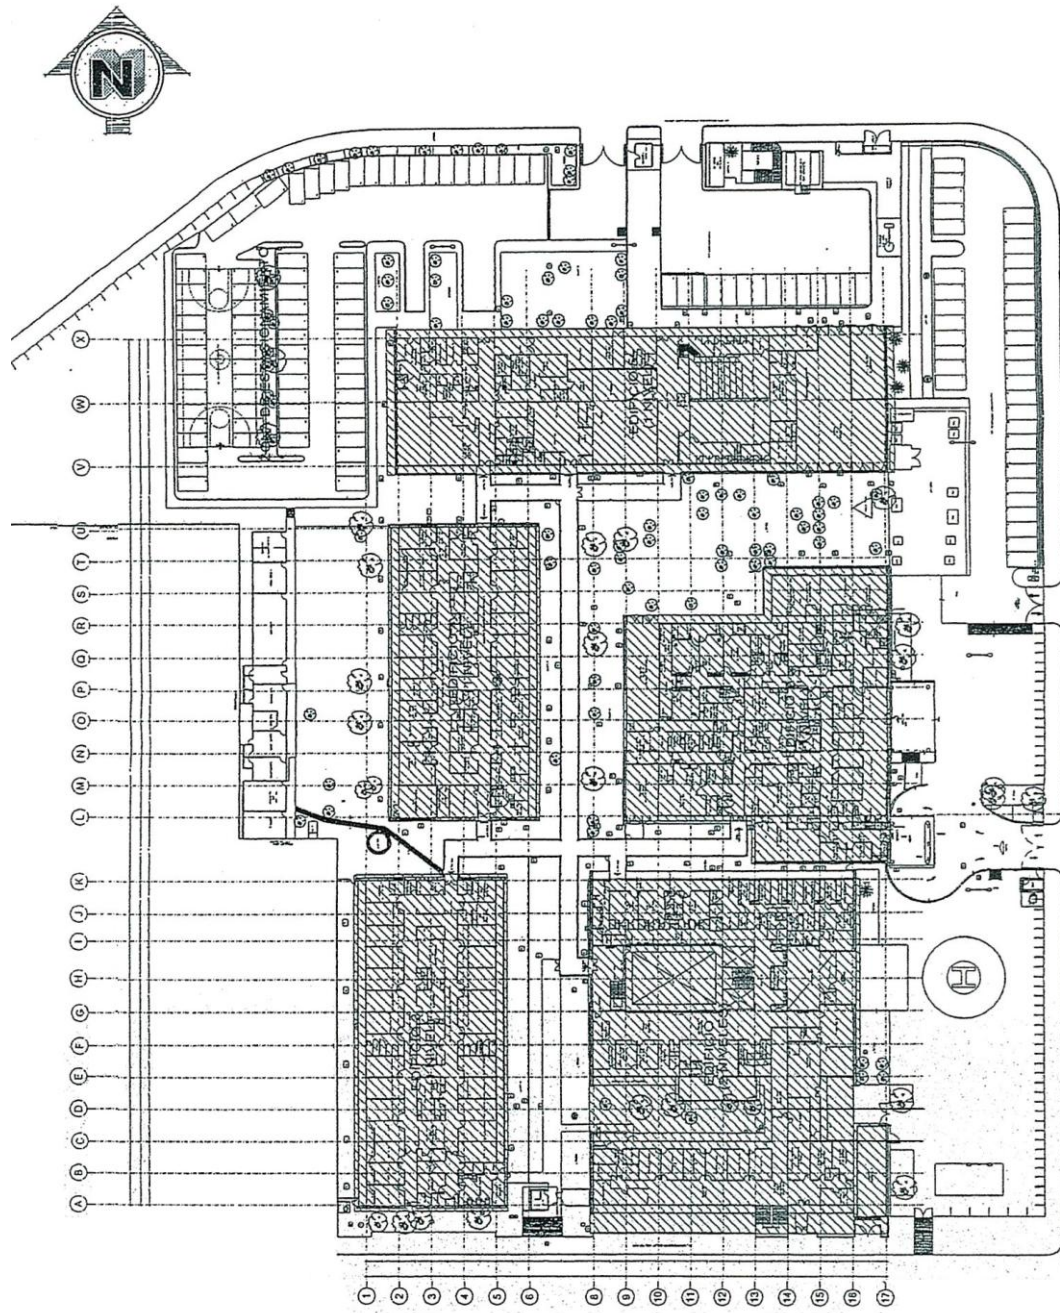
PLANTA ARQUITECTONICA DEL ESTADO ACTUAL DEL HOSPITAL (PLANTA BAJA).
